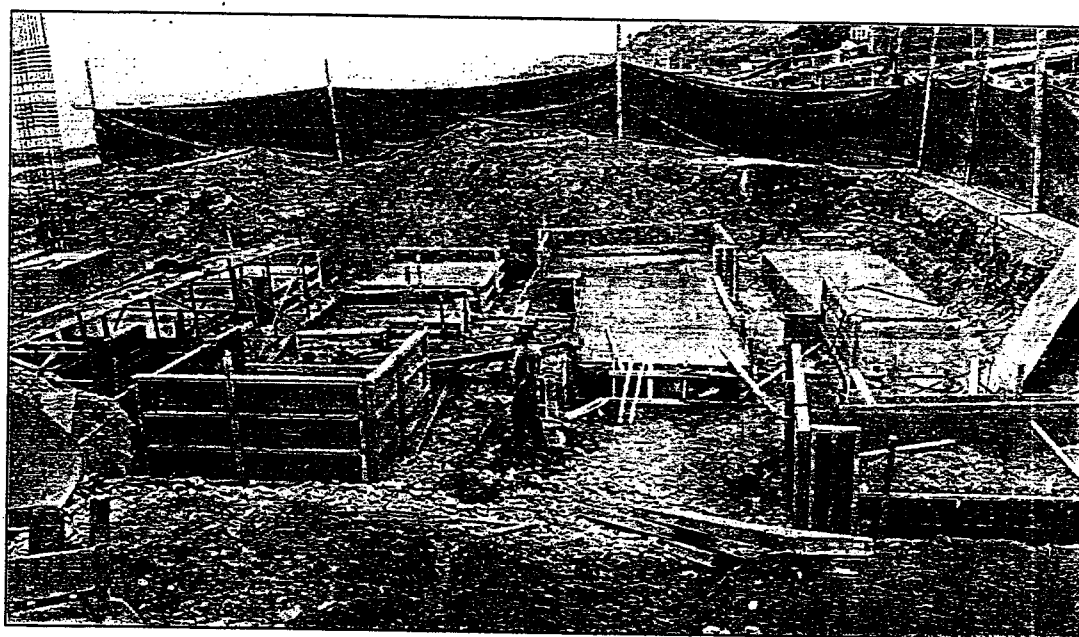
Vista de la ejecución de falsas zapatas cimentadas sobre el suelo mejorado.
